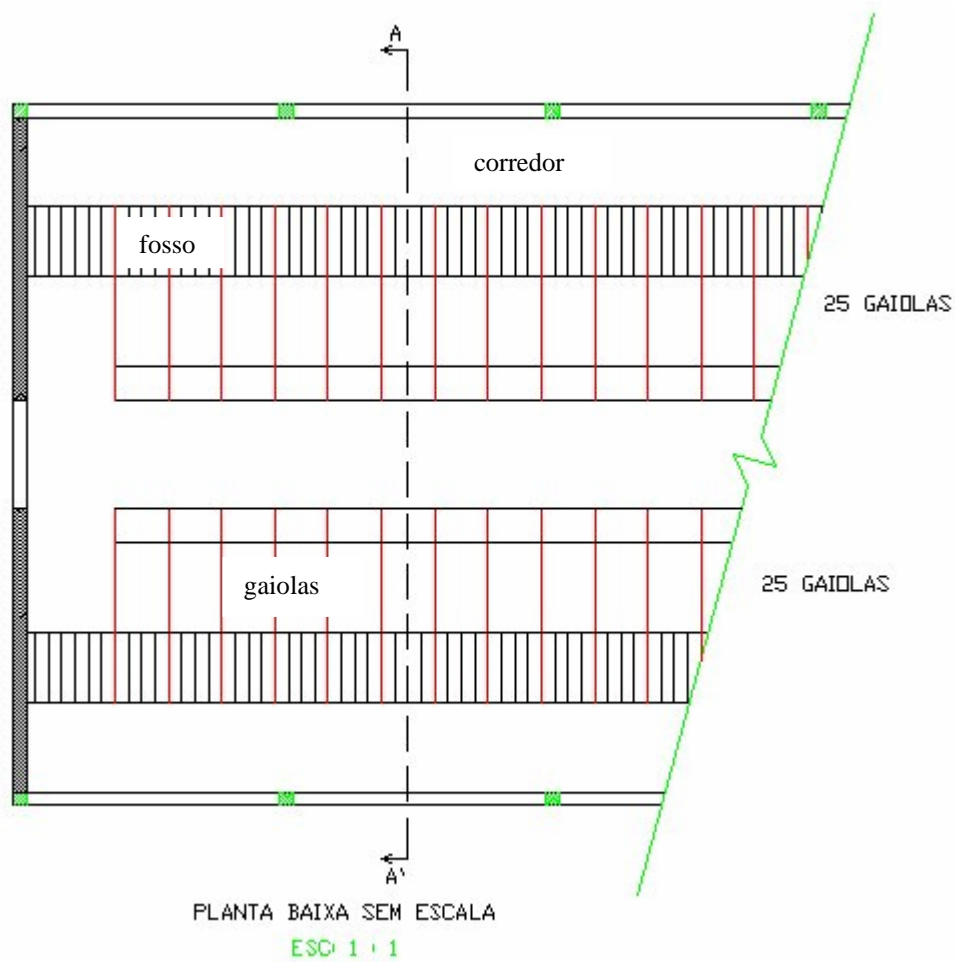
esquema em planta baixa de um prédio com gaiolas individuais de gestação.
